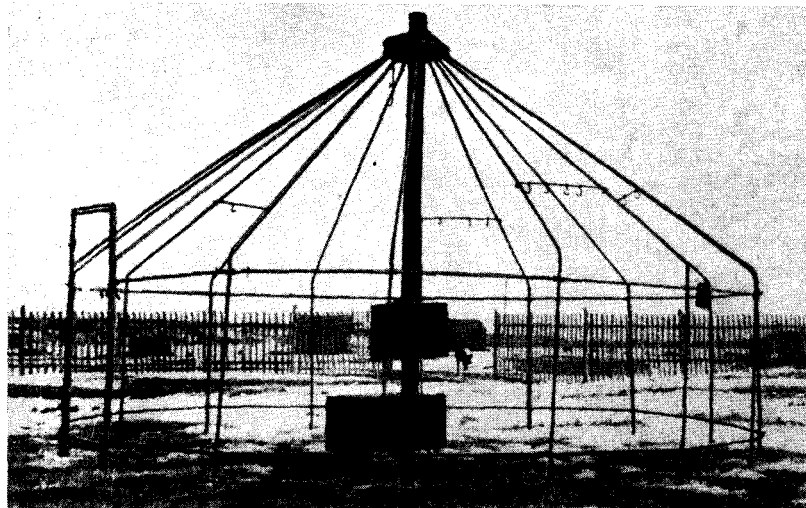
Каркас сборно-разборного тордоха (чума) конструкции Л. Файко и И. Попова
